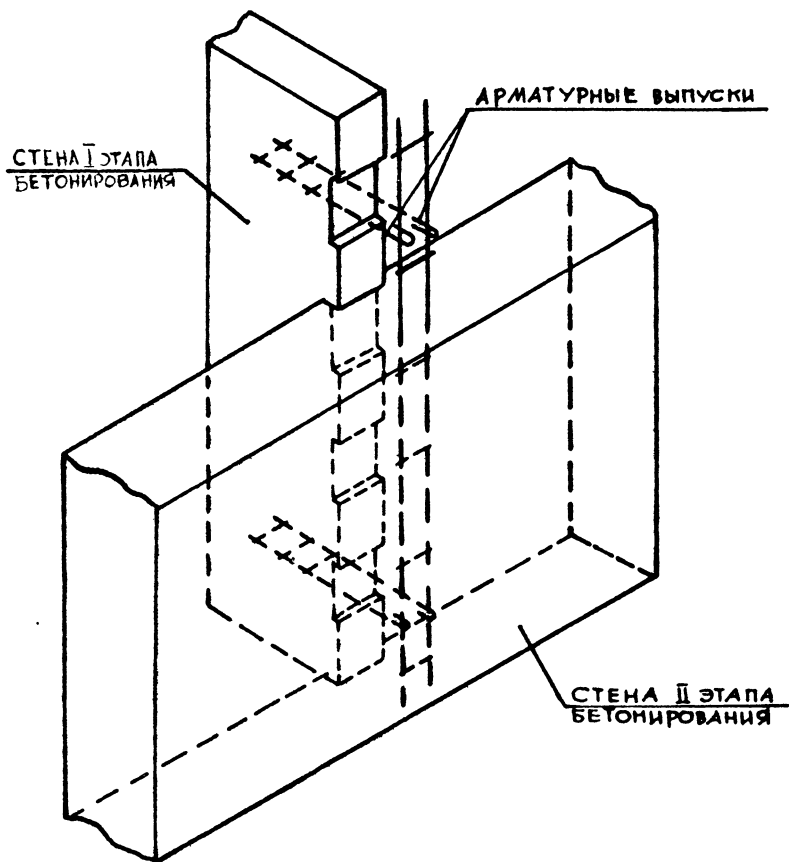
Шпоночные контактные вертикальные стыковые соединения монолитных стен, бетонируемых поэтапно с равномерно распределенными по высоте стены шпонками
